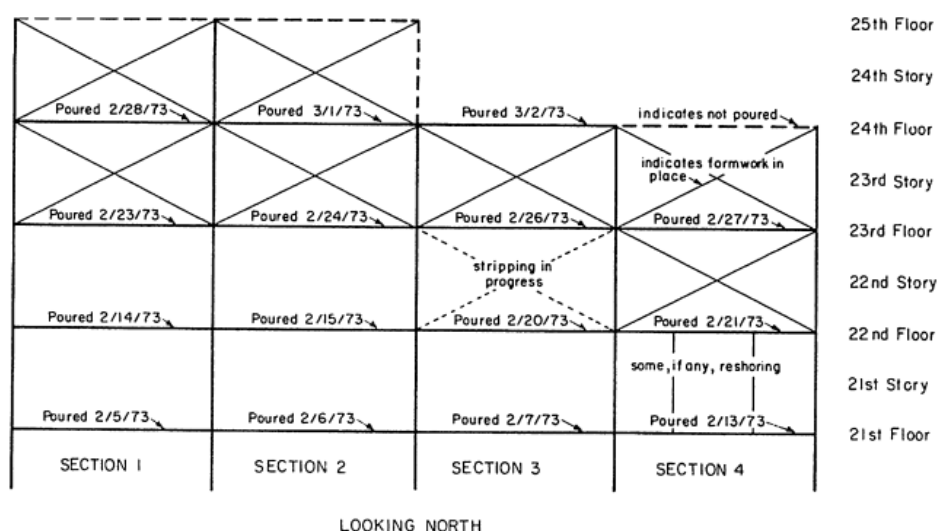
Fases de betonagem na fachada norte – Fonte: (Leyendecker and Fattal, 1977)
